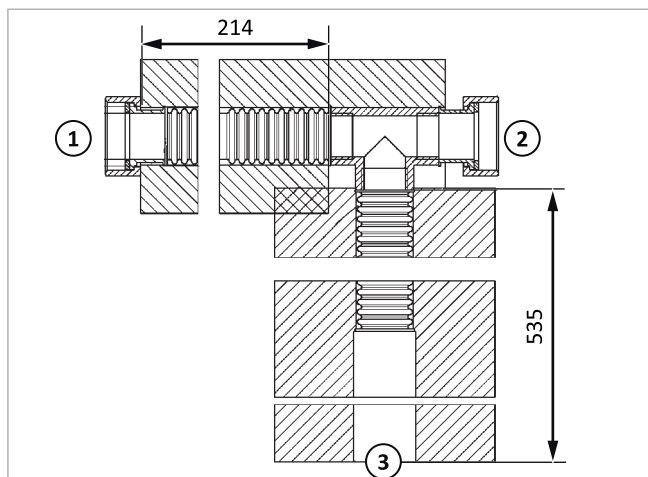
tuyau de raccordement de la chaudière à combustible solide FBK (RO-FBK-RL)
